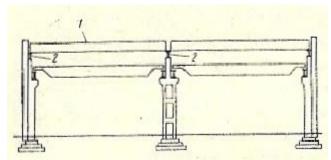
Одноэтажные промышленное здания с плоским покрытием: 1 - длинномерные плиты покрытия; 2 - продольные балки
